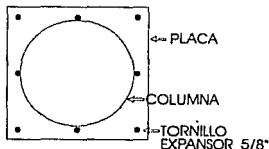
DESPLANTE DE LA COLUMNA DE ESCALERA CENTRAL
